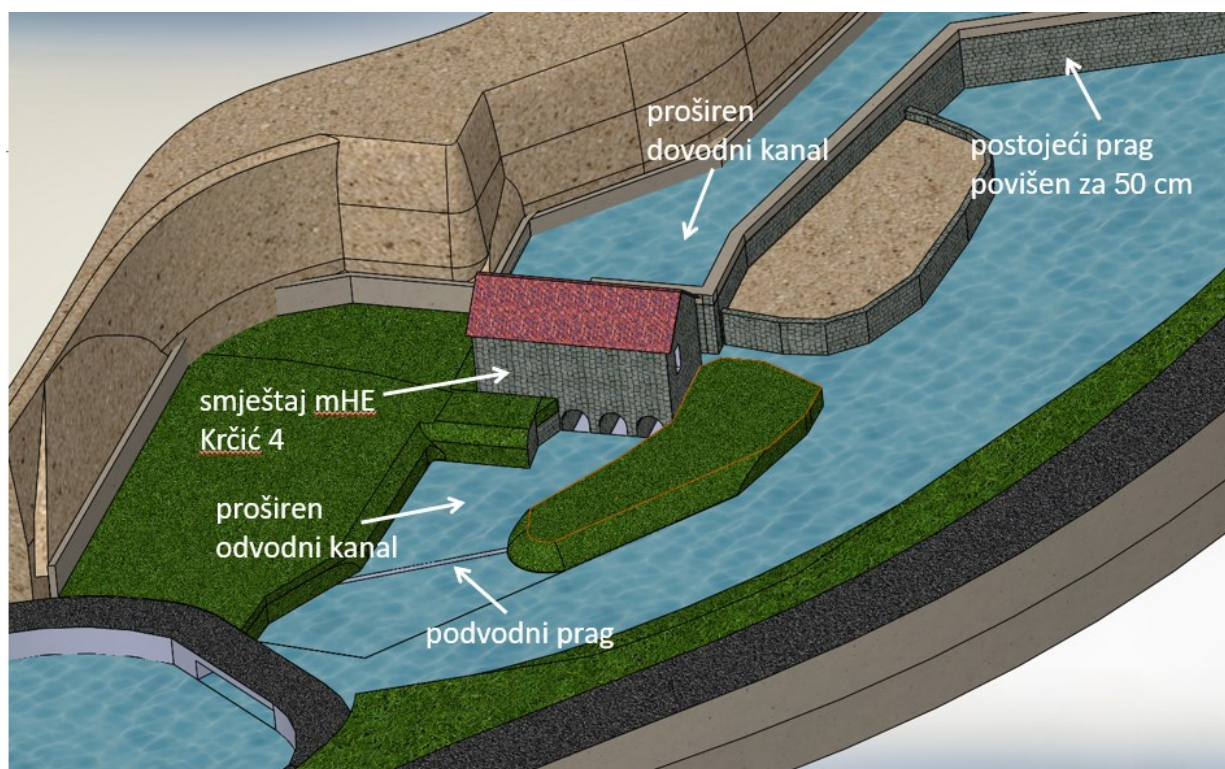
Lokacija planiranog zahvata na Krčiću (Izvor: IRES EKOLOGIJA d.o.o. prema Idejnom rješenju mHE Krčić 4)
